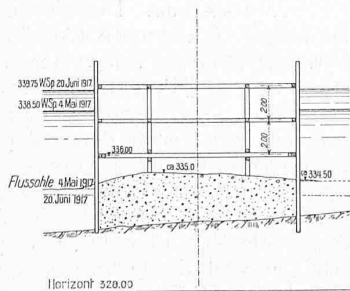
Offene Baugrube, Schnitt 1 : 400.
